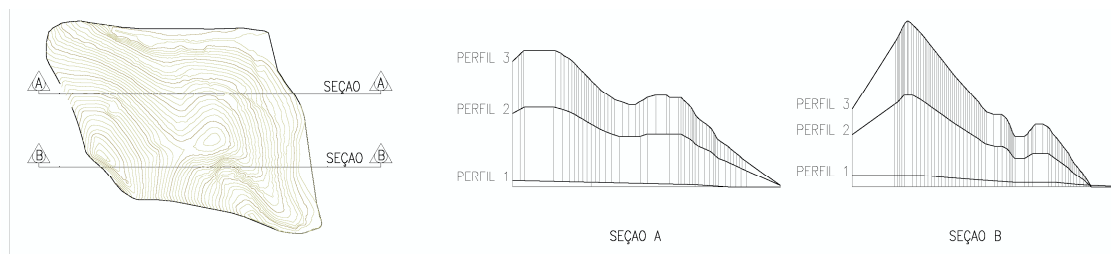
Perfis dos terrenos plano (perfil 1), ondulado (perfil 2) e forte ondulado (perfil 3).
